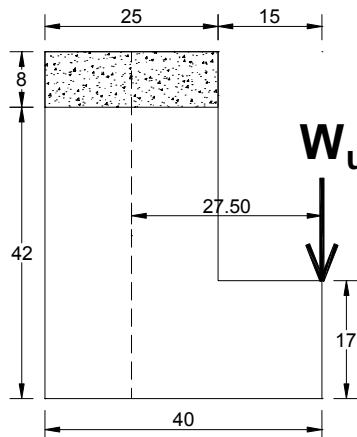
Diseño por cortante y torsión (dimensiones en cm)
